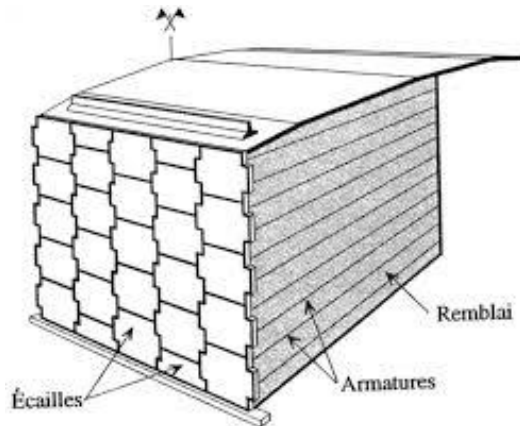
Vue d'un mur d'un Soutènement en terre armée
